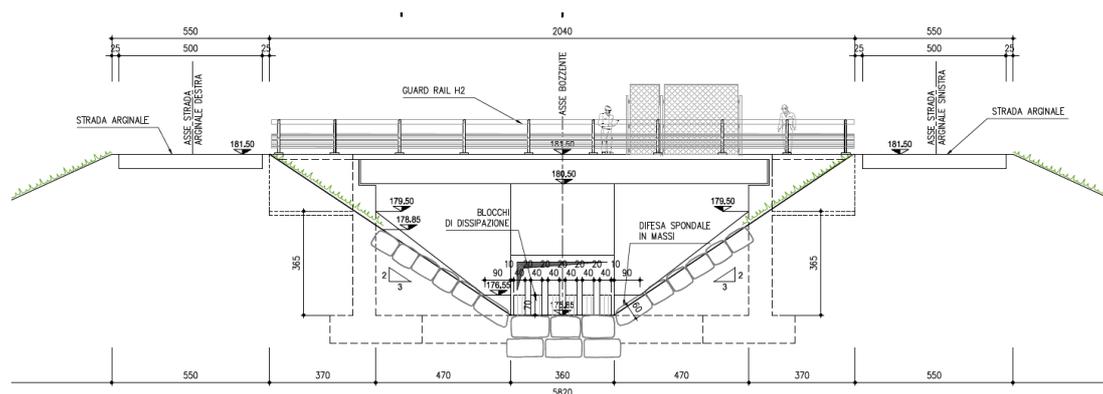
Sezione trasversale – manufatto di attraversamento in adiacenza al manufatto di regolazione
